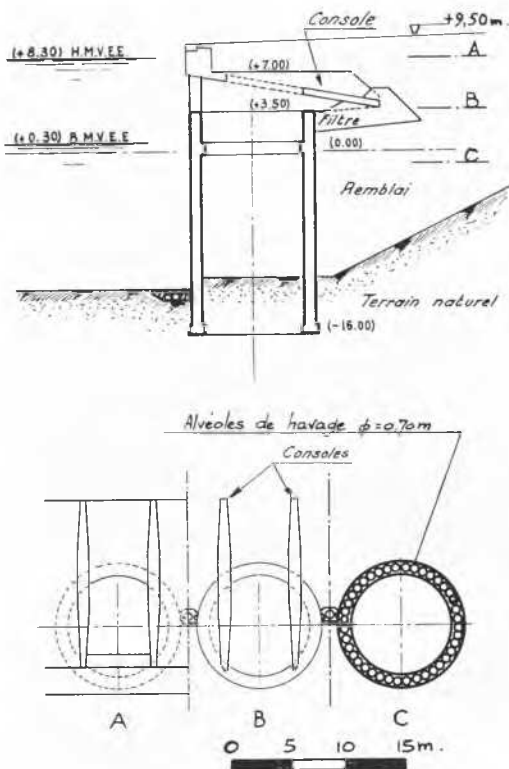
Quai de la Floride : coupe transversale dans l'axe d'une pile et plan.
